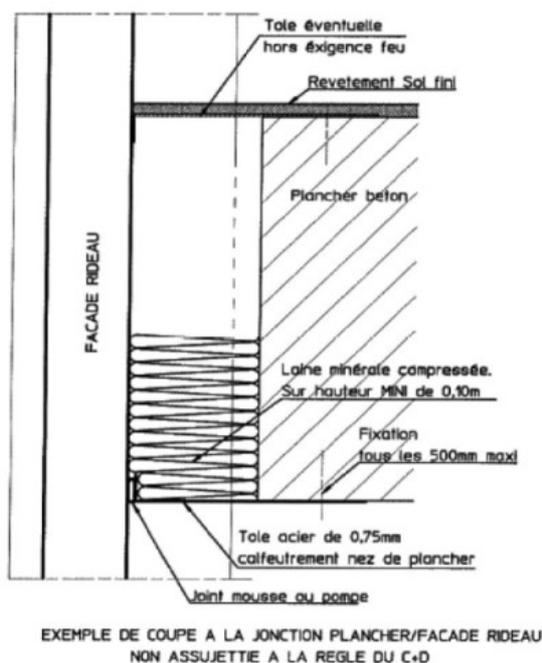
exemple de jonction façade/plancher lorsque le C + D n'est pas appliqué
